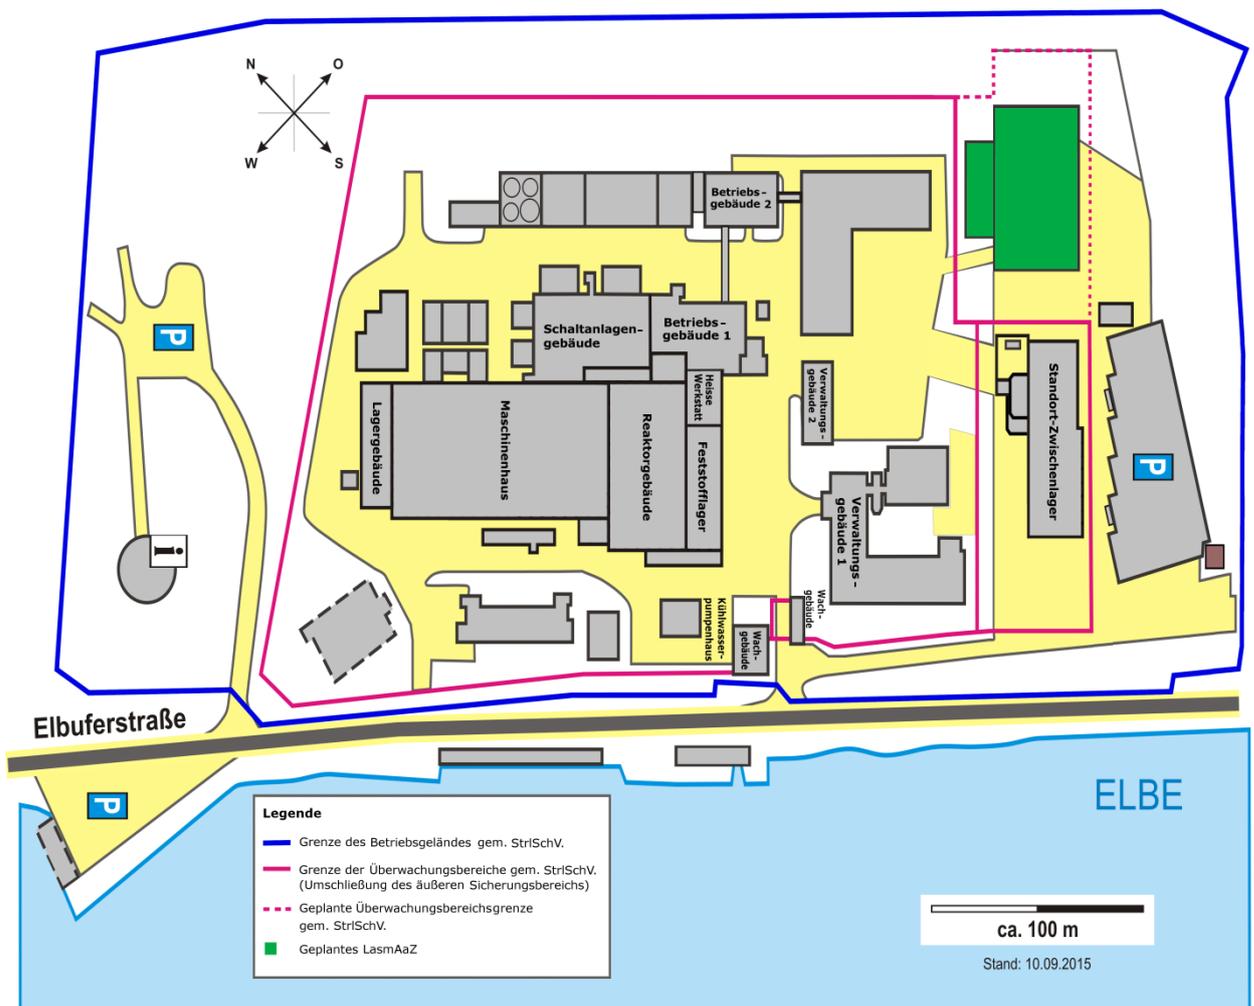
Lageplan für den Standort KKK mit LasmAaZ
